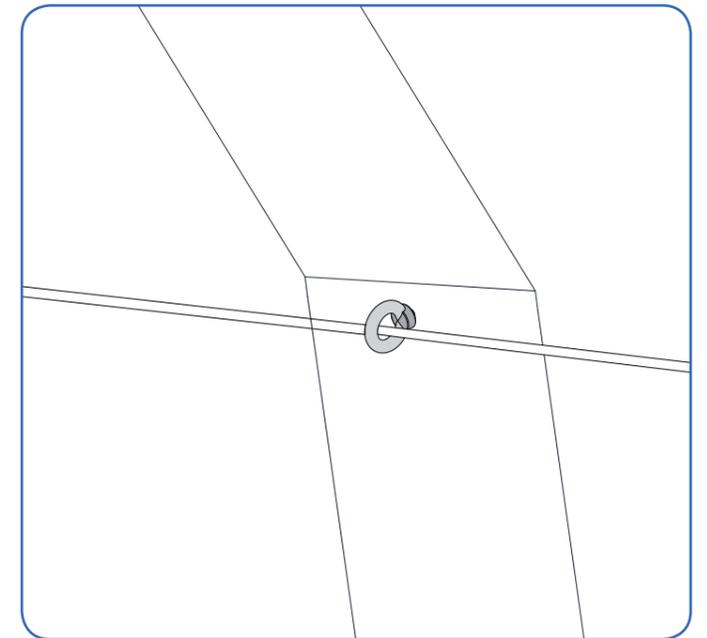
Para comprobar que la línea está bien instalada, debemos comprobar que la sirga no toca las paredes de las argollas.
